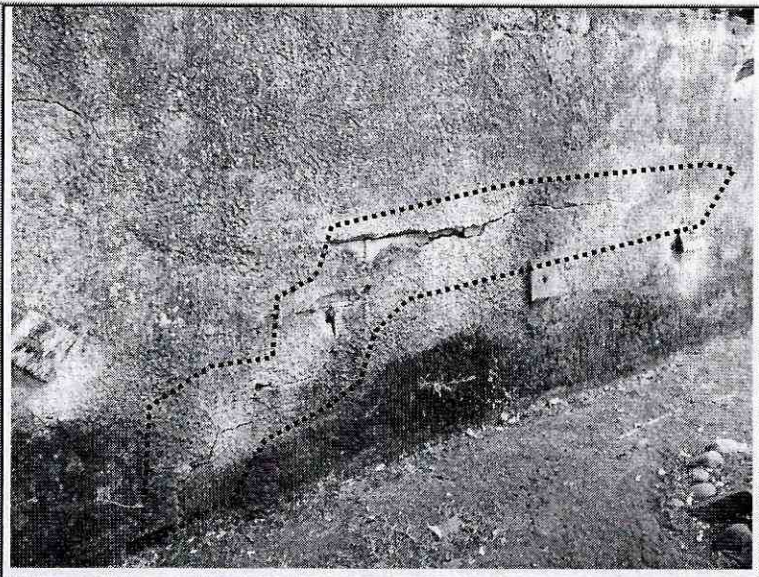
y 2. Vista del muro divisorio ubicado entre los predios de la Carrera 20A # 172-30 y la Calle 170 # 19B-62.
